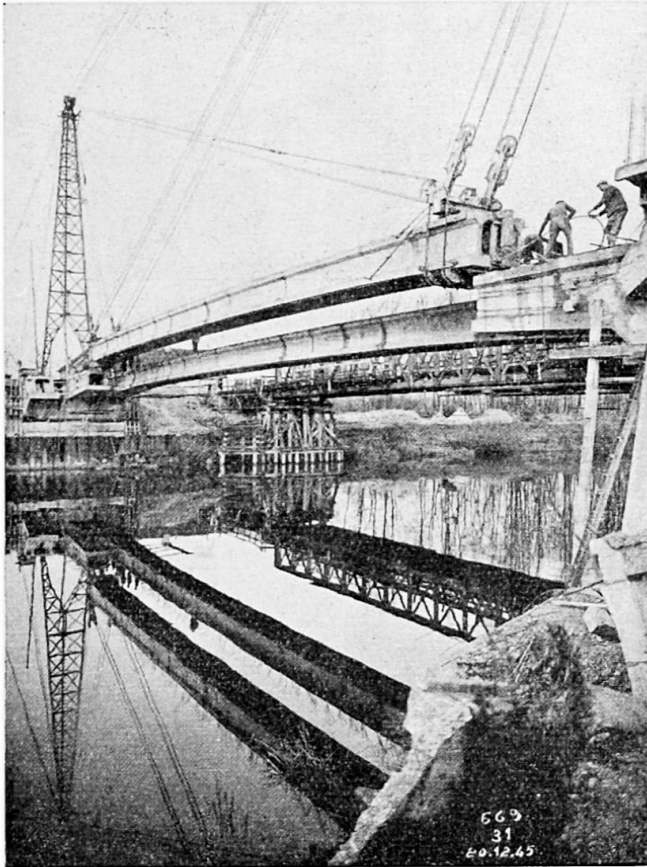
Mise en place d'une poutre du pont de Luzancy.
